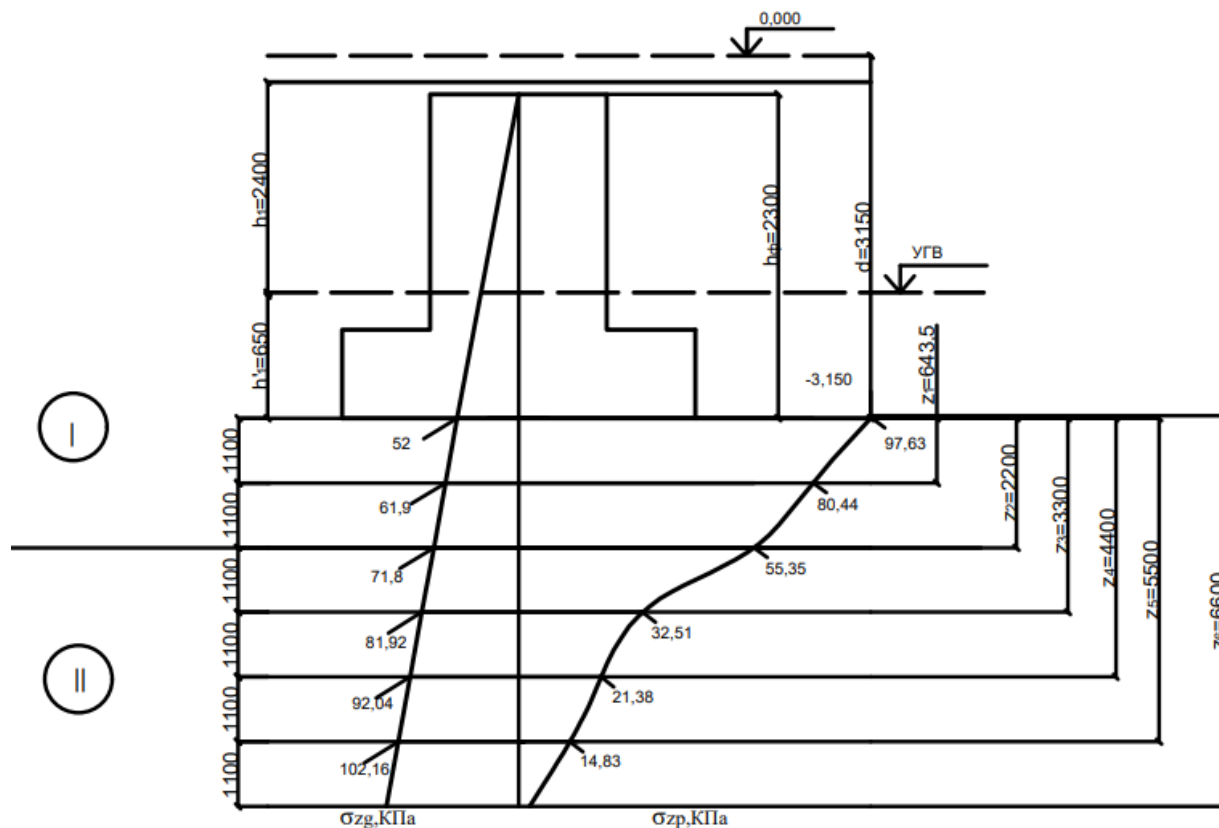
Расчетная схема к определению напряжений в грунте под подошвой фундамента
